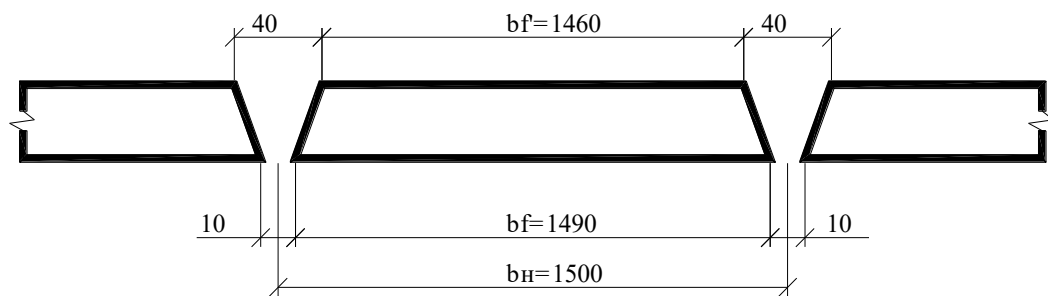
Конструктивна ширина плити та монтажних зазорів
